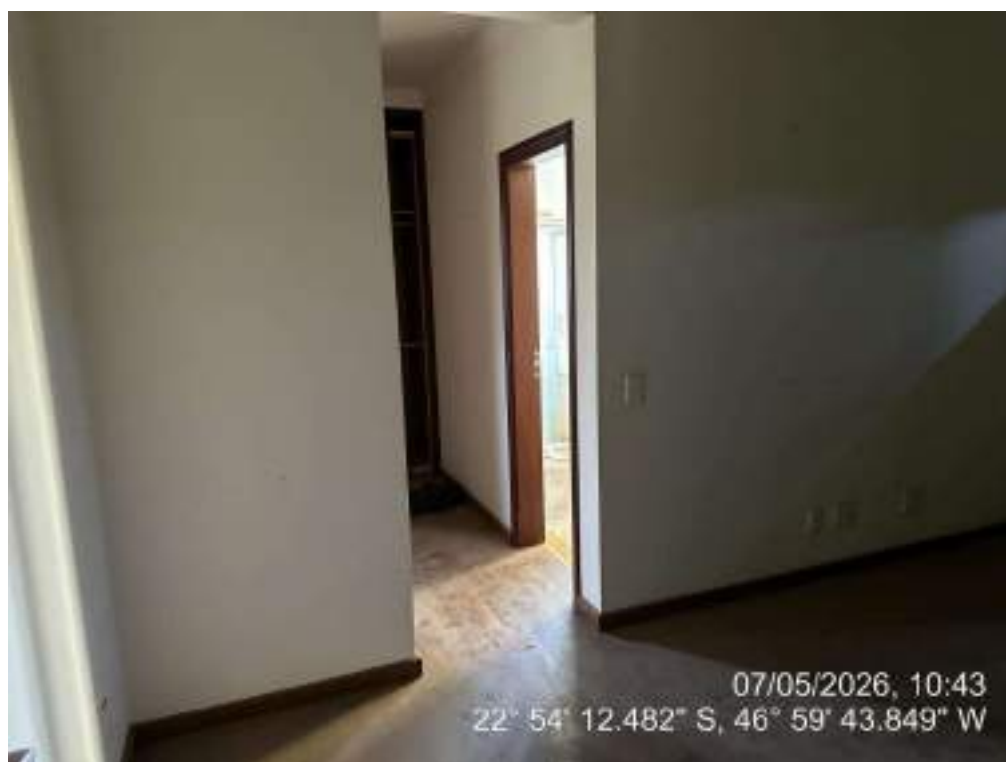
PAV SUPERIOR – SUÍTE MASTER
